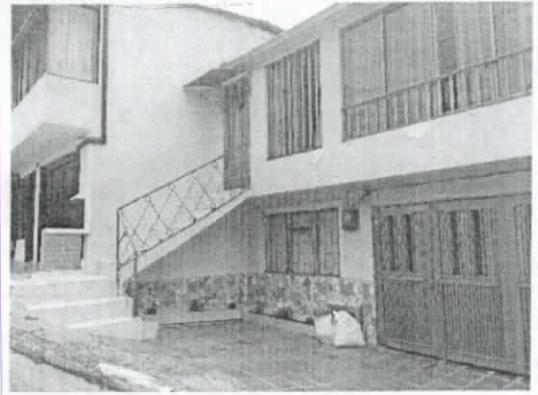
Estado actual del predio ubicado en la Calle 65B No. 41-19.
